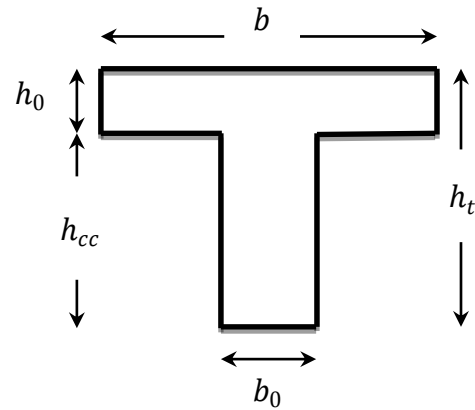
Caractéristiques géométriques d'une poutrelle
